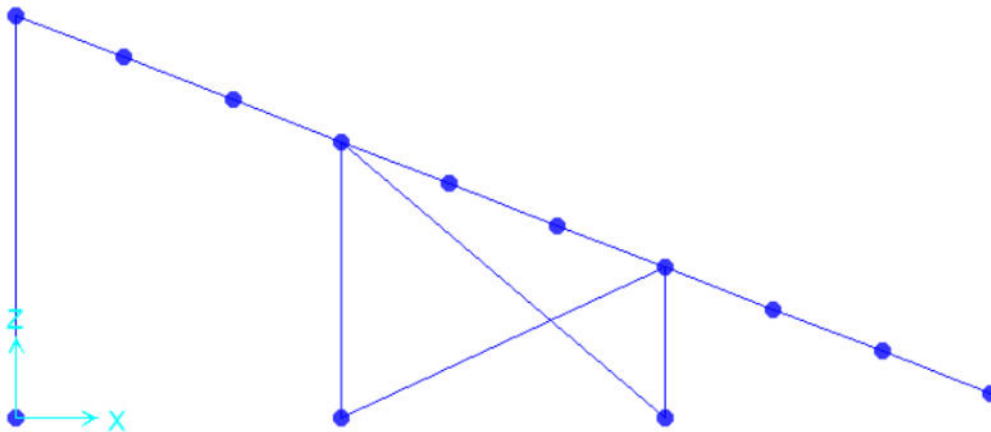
Modello SAP2000 struttura – Sezione longitudinale
